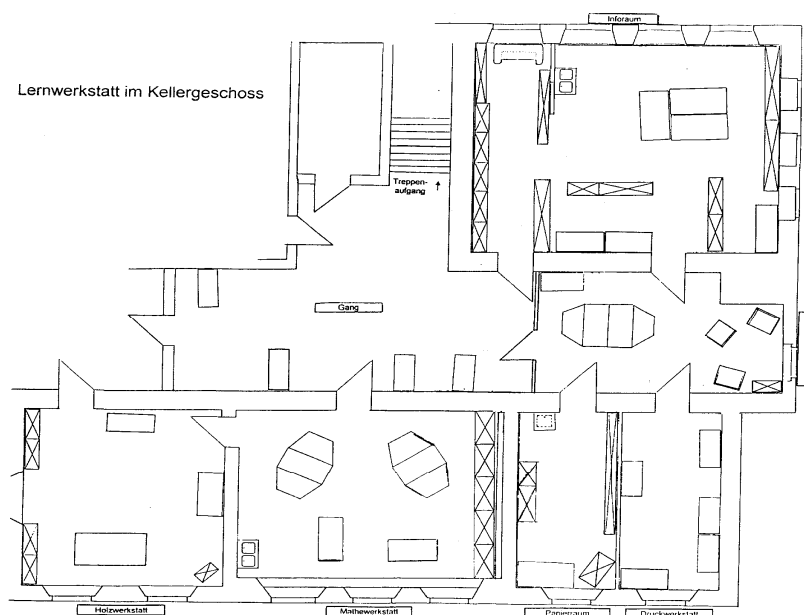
Architektenzeichnung des Grundrisses einer Lernwerkstatt
